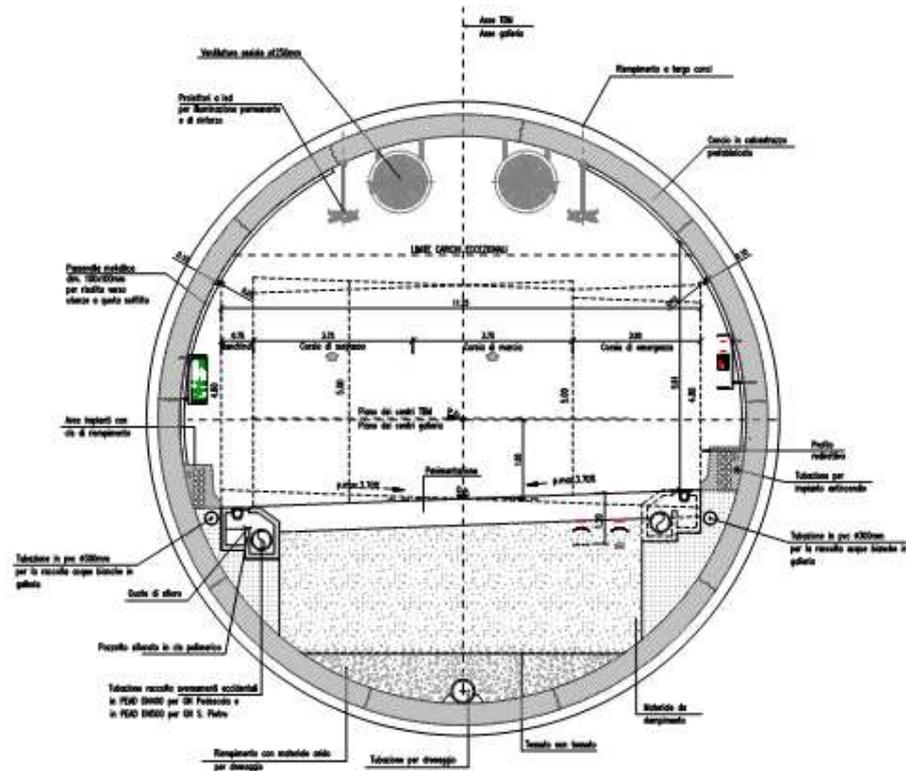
Sezione tipo in galleria naturale con scavo meccanizzato
